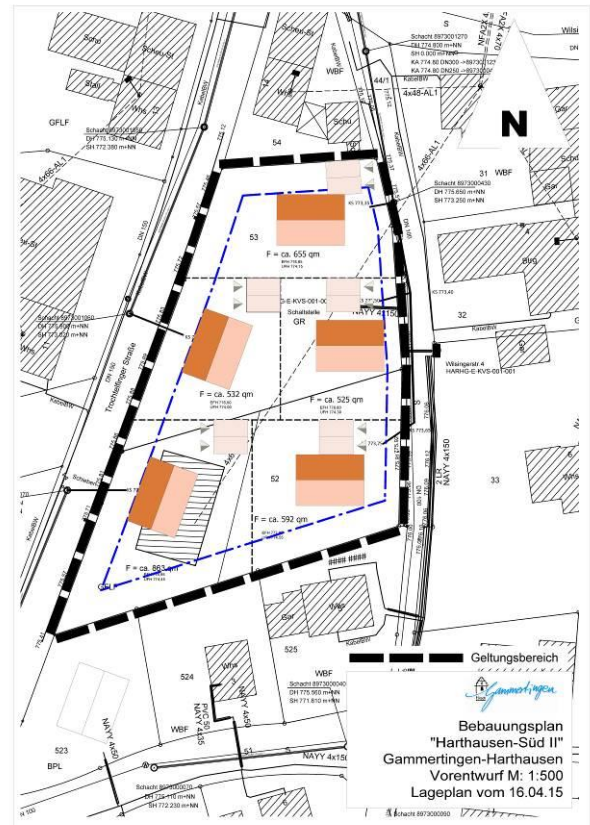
Entwurf des Bebauungsplans, Stand 16. April 2015 (unmaßstäblich)
